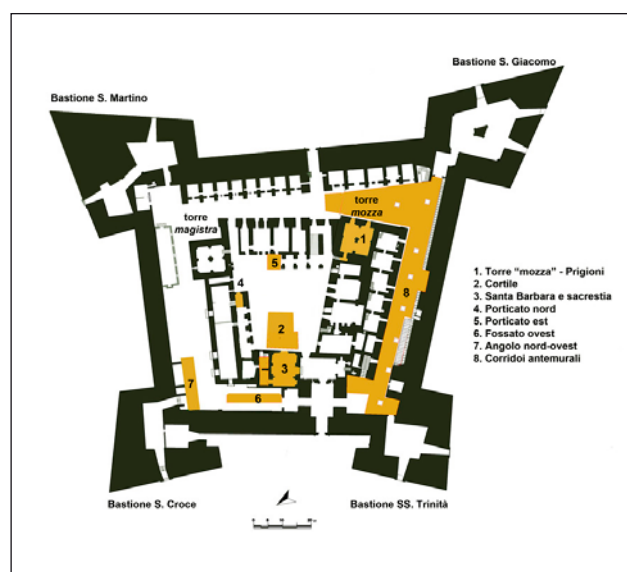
Planimetria generale del Castello con le aree di intervento archeologico (LAM).
